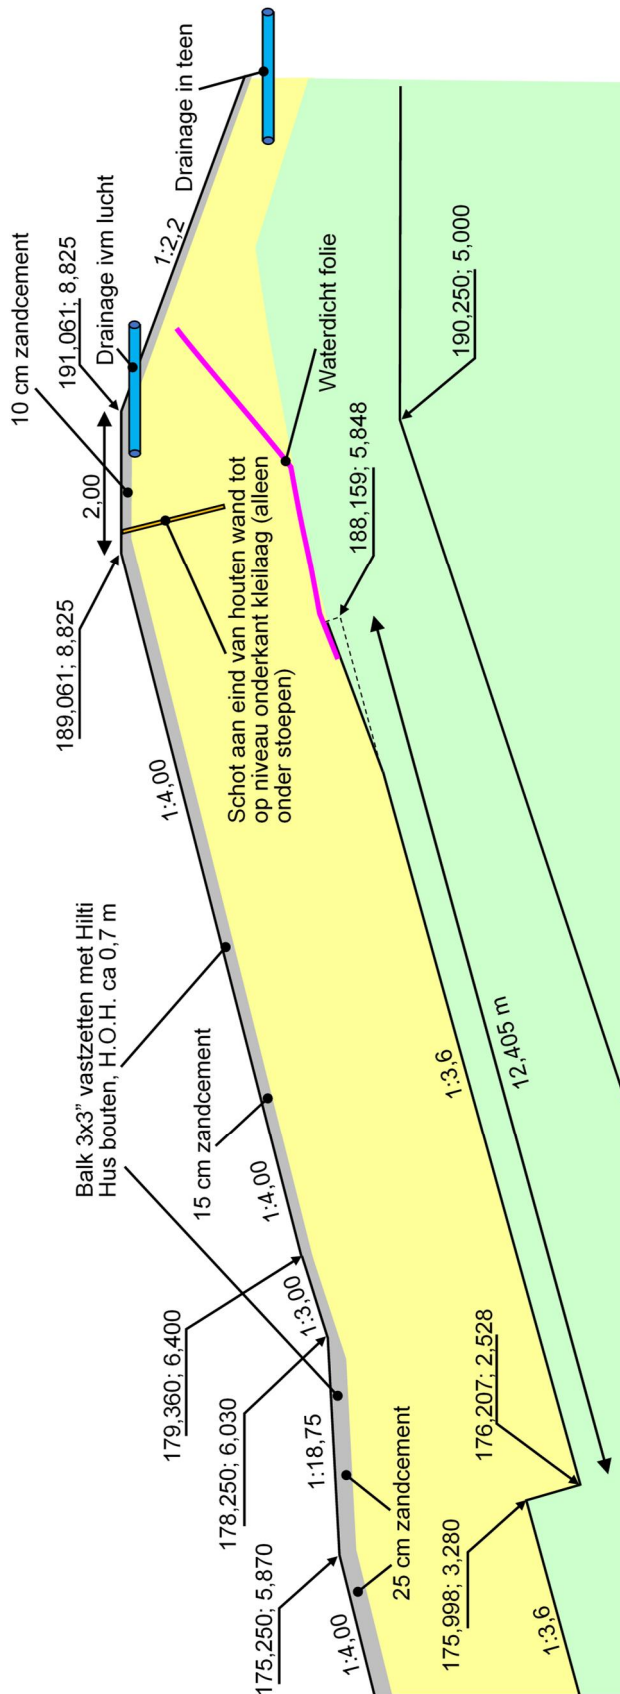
Verticale langsdoorsnede betontaluds naast de modelsectie (alle proevenseries)
